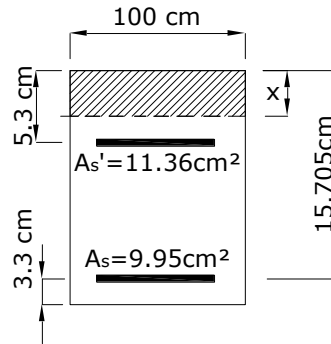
Sección fisurada para momento positivo
